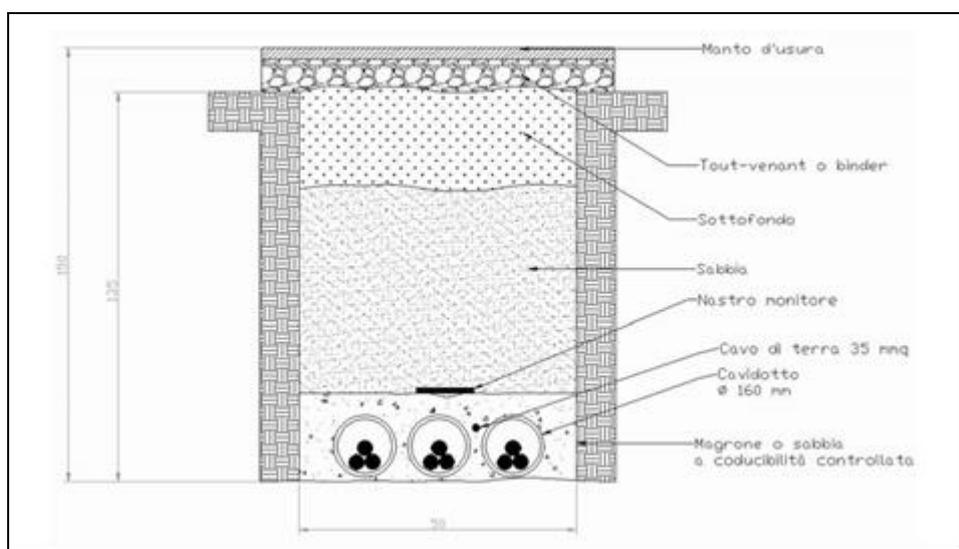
Sezione tipo di posa con n°3 terne di cavi
